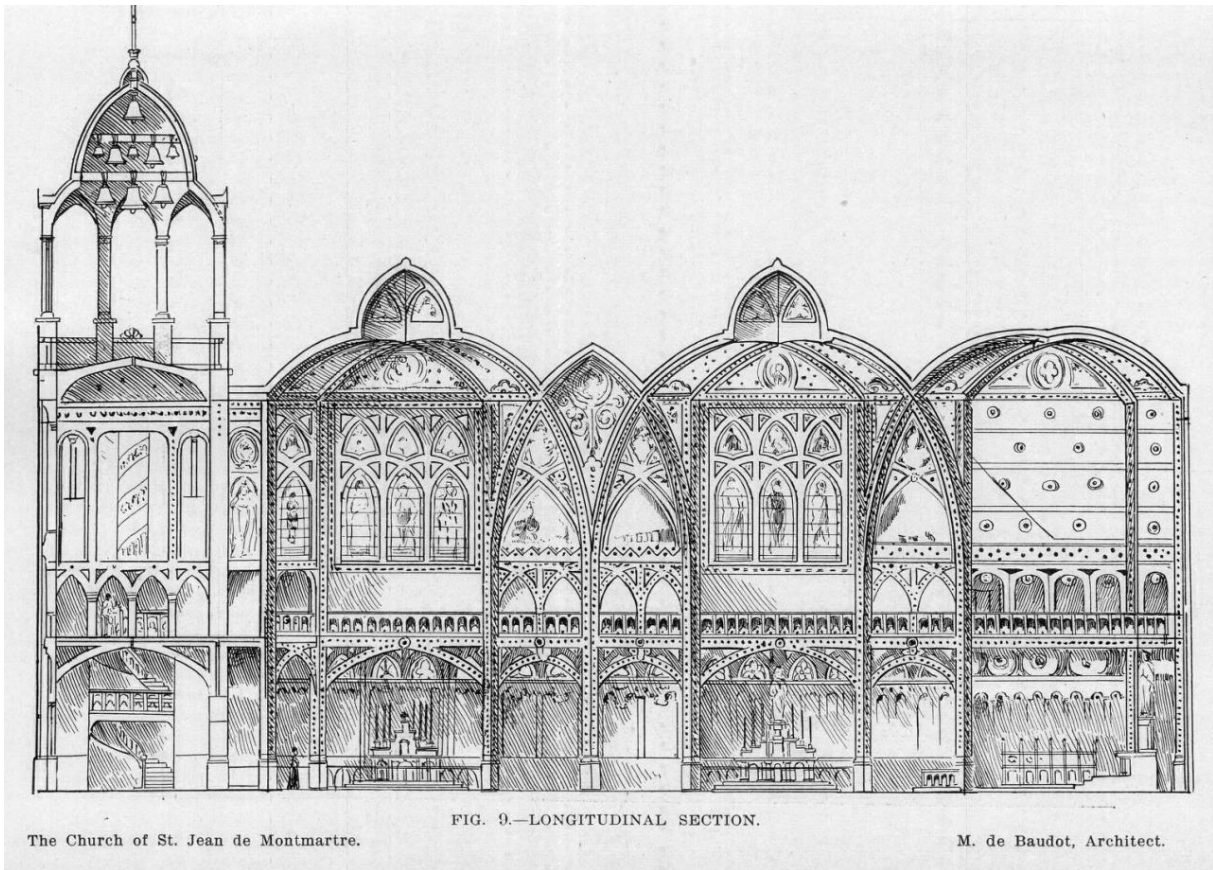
Aufriss des Kirchenbaus <sup>[32]</sup>
